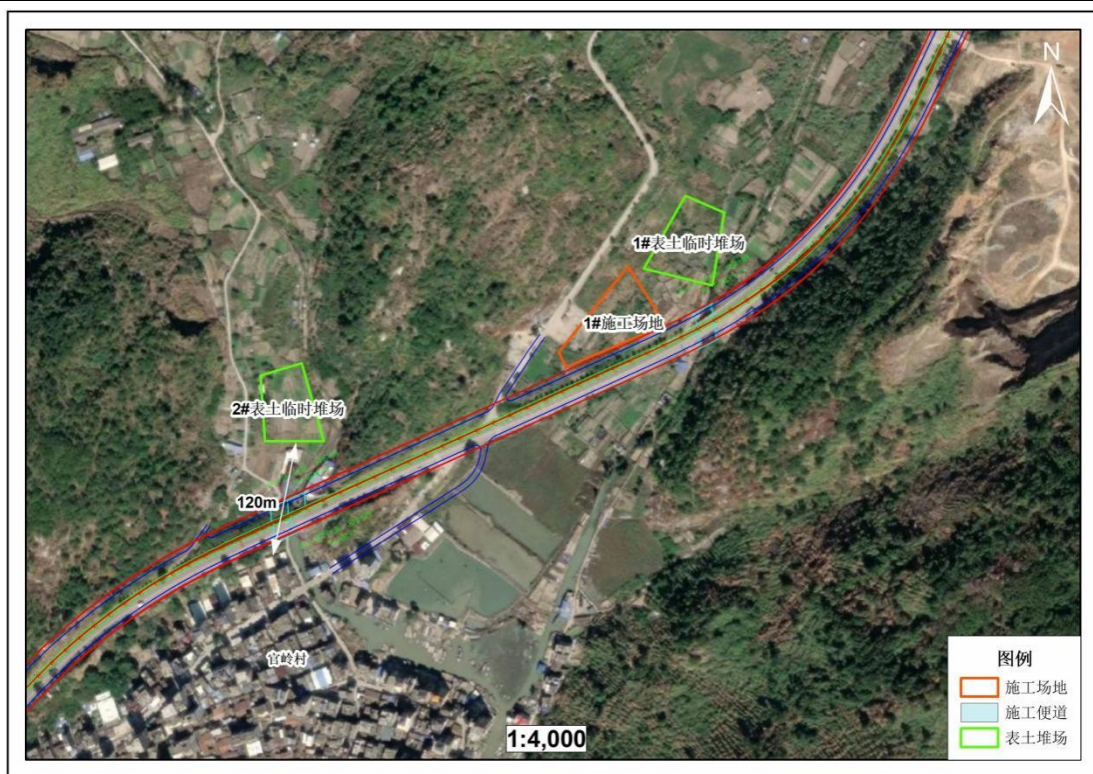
临时工程平面布置示意图 (1#、2#表土堆场、1#施工场地)
